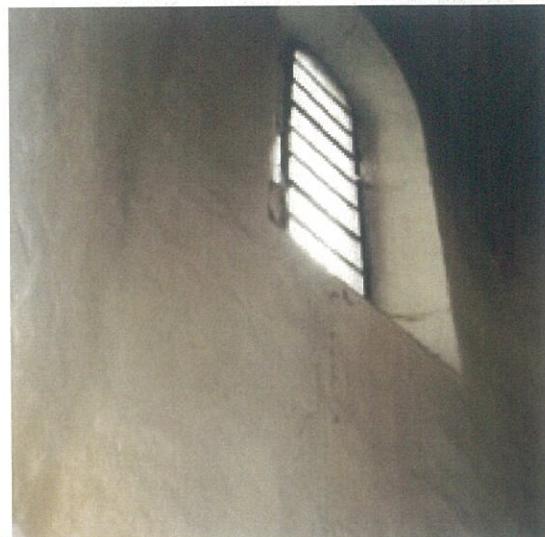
Infiltrări ale apelor pluviale, prin ferestre.
